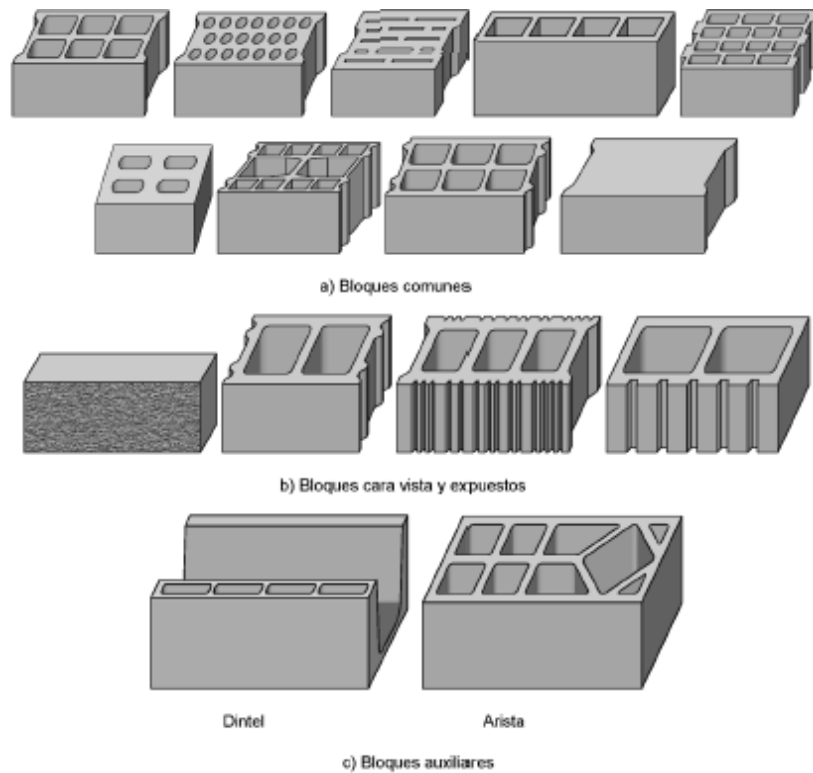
Bloques de hormigón (Fuente: norma EN 771-3)
